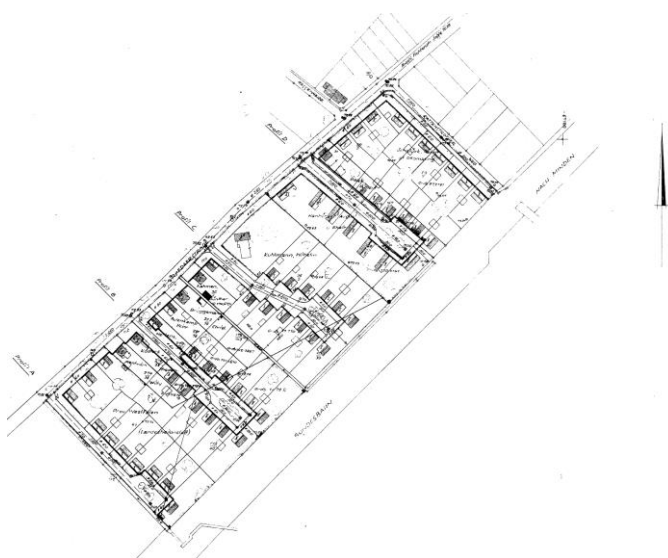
D-Plan Nr. 1 "Rhedaer Strasse", der erste Bauleitplan der Stadt Gütersloh (1955). Mit noch geringem Regelungsaufwand lieferte er die planungsrechtlichen Grundlagen für eine I-geschossige EFH-Bebauung und sah bereits Garagen vor. Die Straßennamen - "Thüringer Weg, Brandenburger Weg, Sachsenweg, Frankenweg, Mecklenburger Weg" waren Ausdruck der Selbstvergewisserung der zugezogenen Flüchtlinge und Vertriebenen. Quelle: Datenbank der Stadt Gütersloh.
